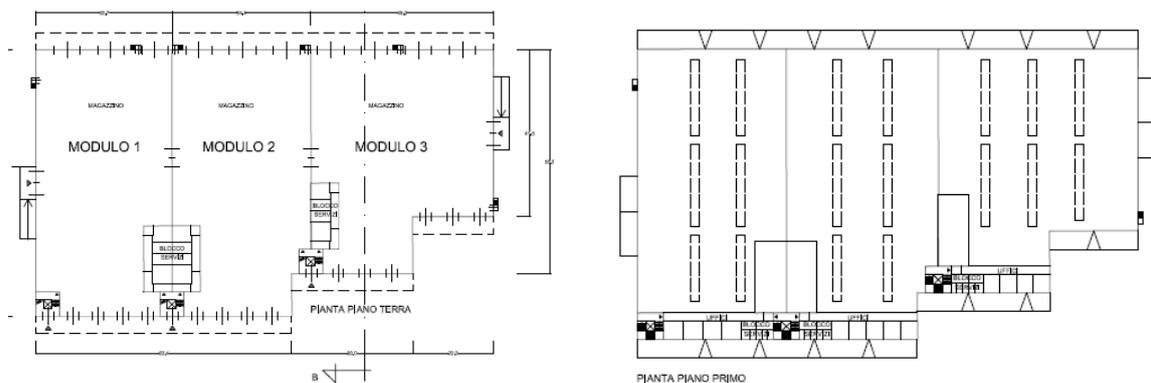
Pianta piano terra e pianta primo piano. Magazzino 14O
